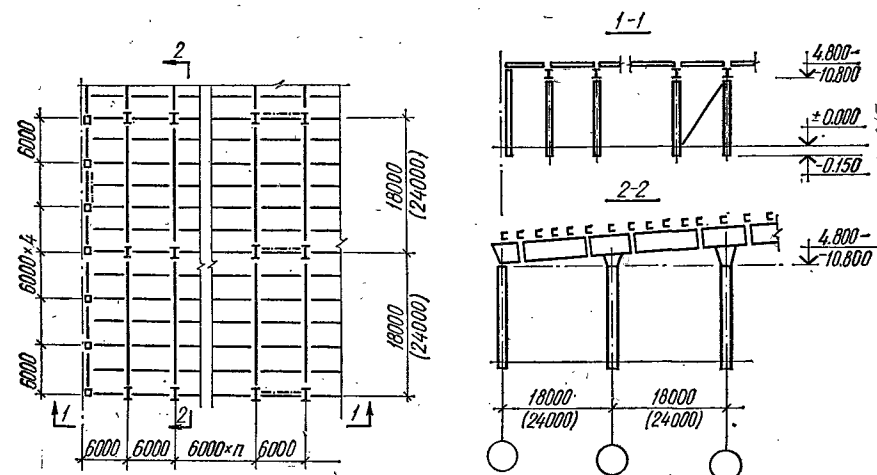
Схема каркаса здания с рамными конструкциями типа «Канск».
